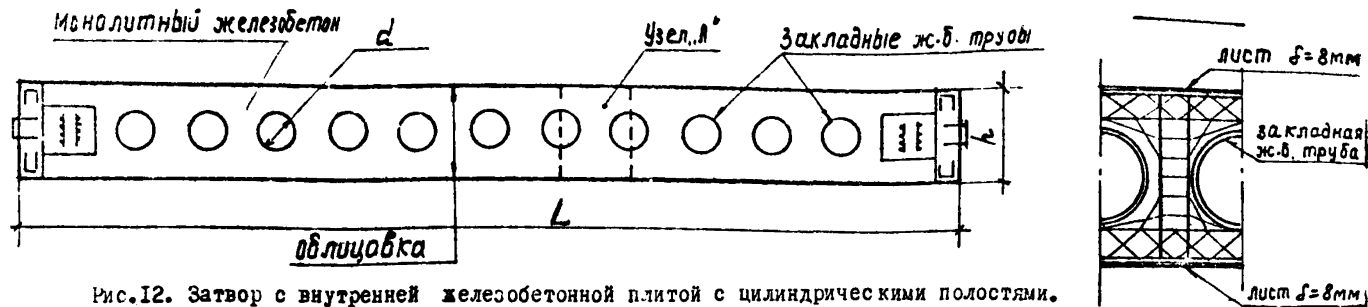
Затвор с внутренней железобетонной плитой с цилиндрическими полостями.
